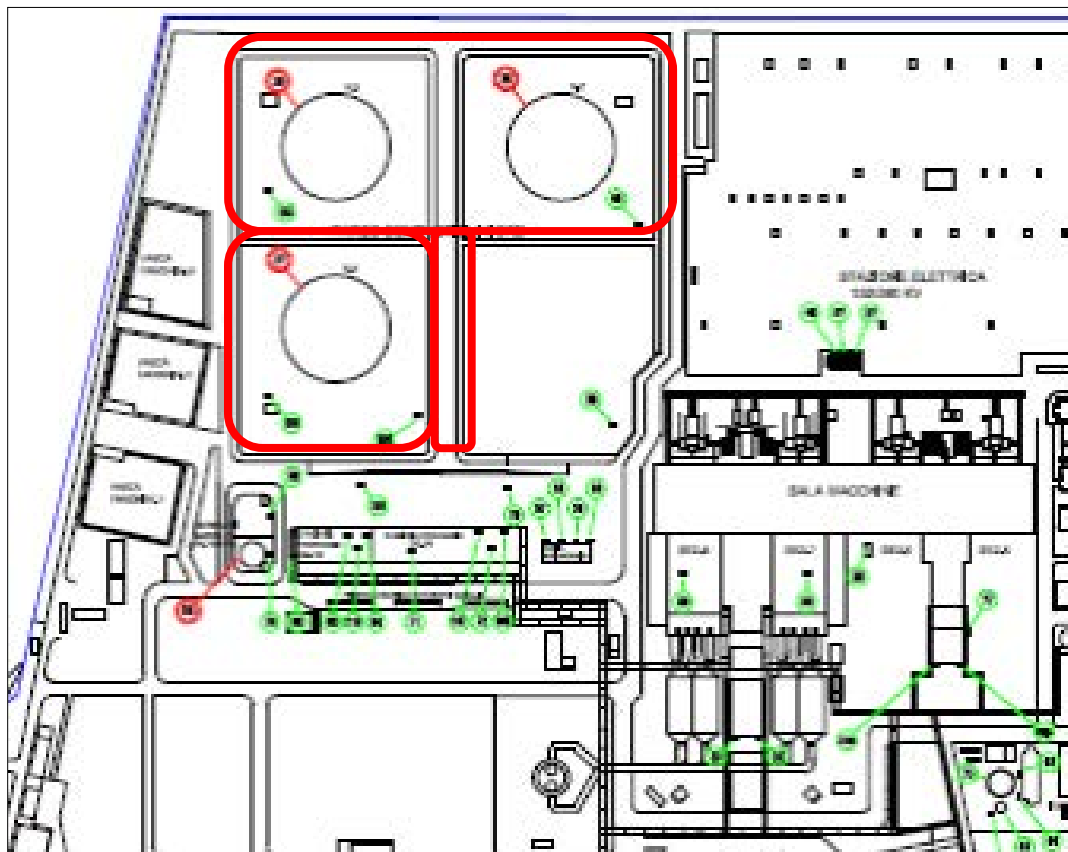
Pianta schematica delle aree d'intervento nel Parco Nord – FASE 2.
